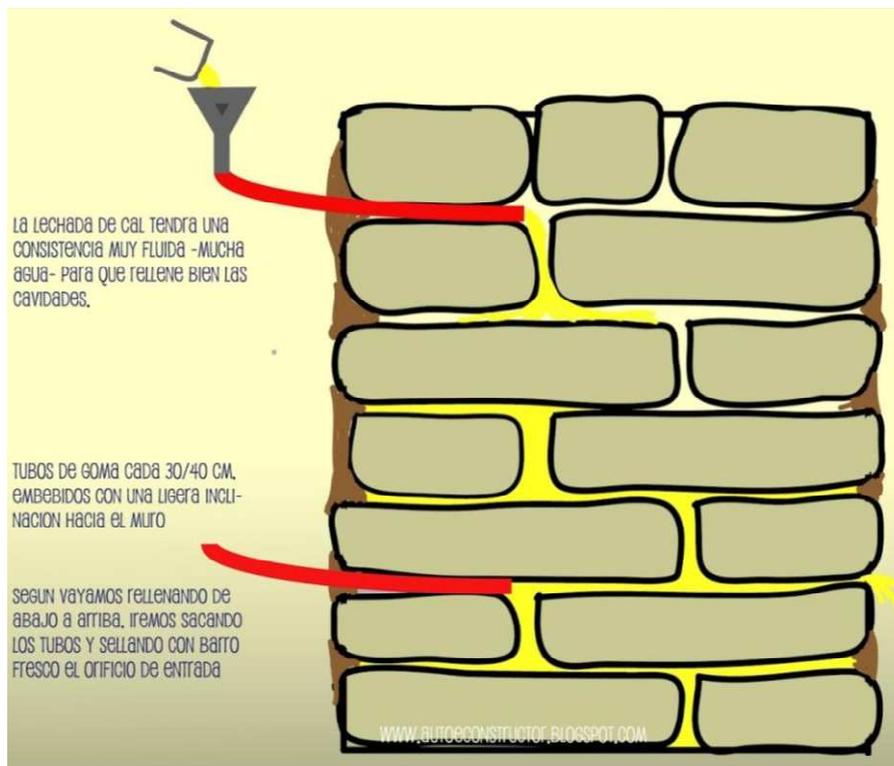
Esquema de consolidación de muros de mampuesto con rejuntados a base de cal. (foto alterada por el autor) Fuente:
